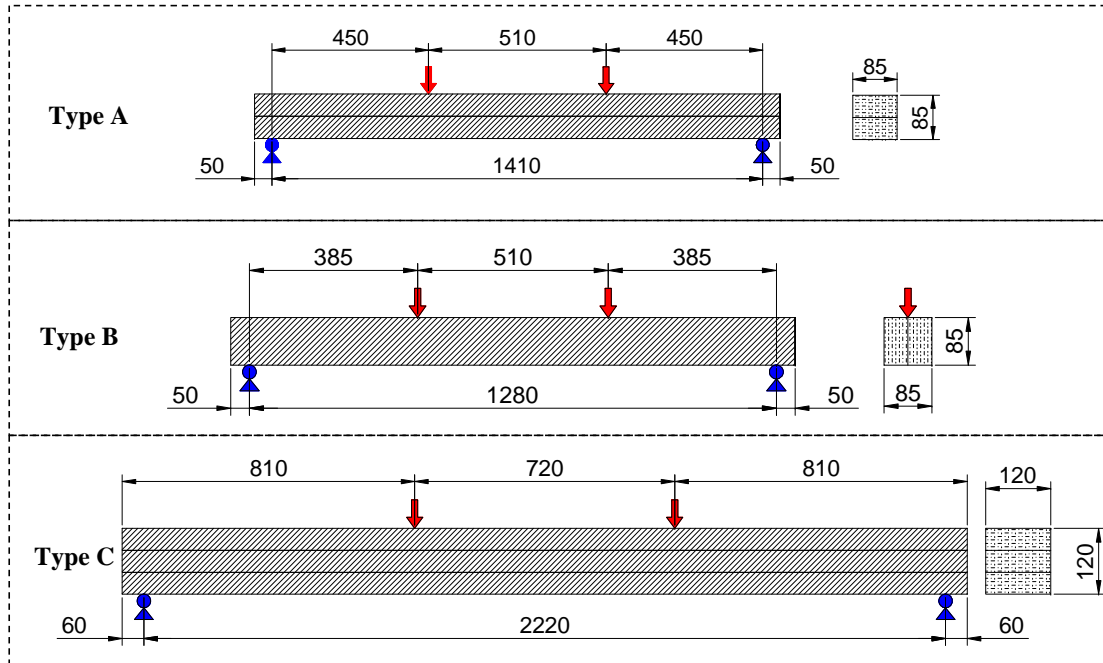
Différentes configurations des poutres multicouches sans aboutage
